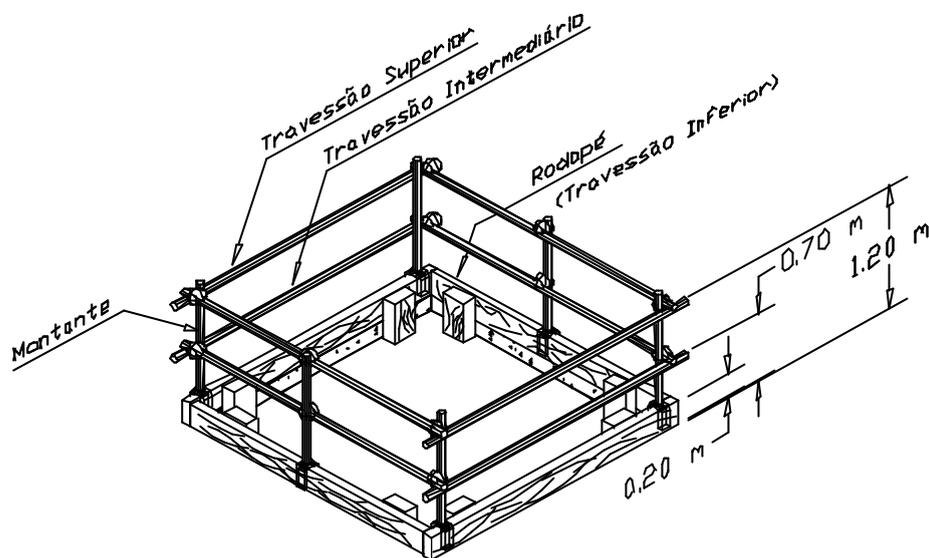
Proteção pelo sistema GcR de madeira e de estruturas metálicas
